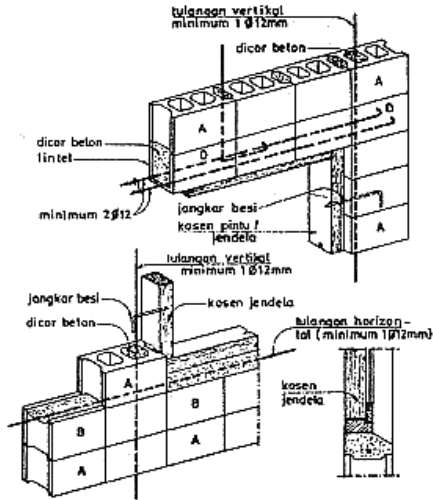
Rumah bertingkat blok beton dengan tulangan sebaiknya tidak lebih dari 2 (dua) lantai.
